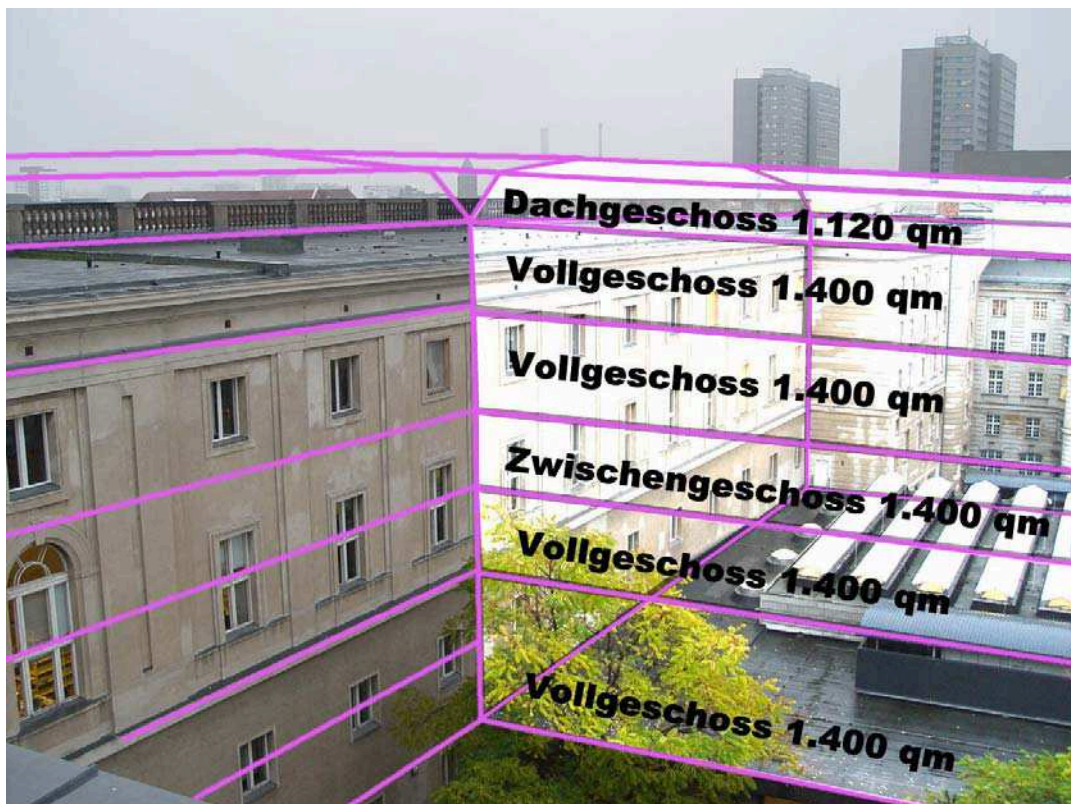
Gebäudeüberbauung mit 5 Voll- und einem Dachgeschoss über dem Lesesaal von Haus 2
